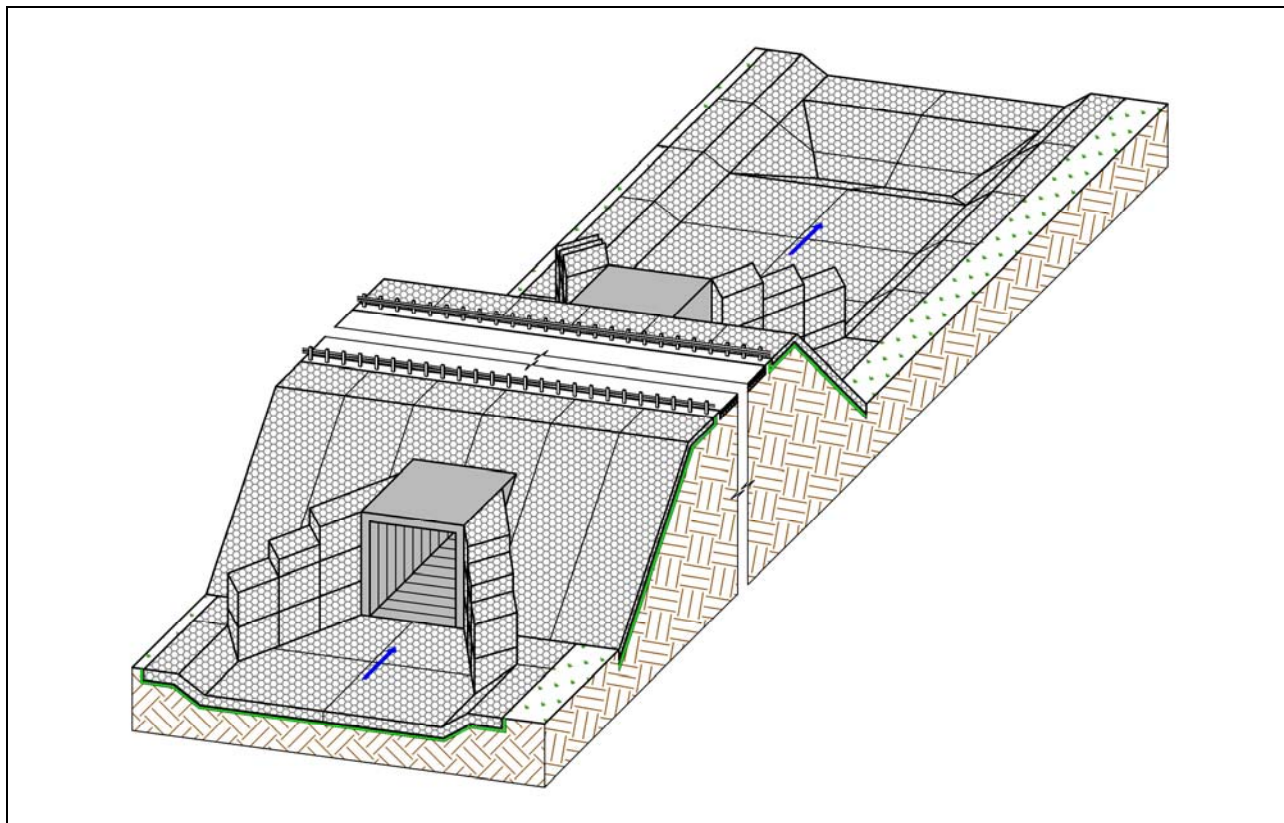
(продолжение) Укрепление оголовков водопропускной трубы открылками и дорожных откосов из габрионных конструкций
